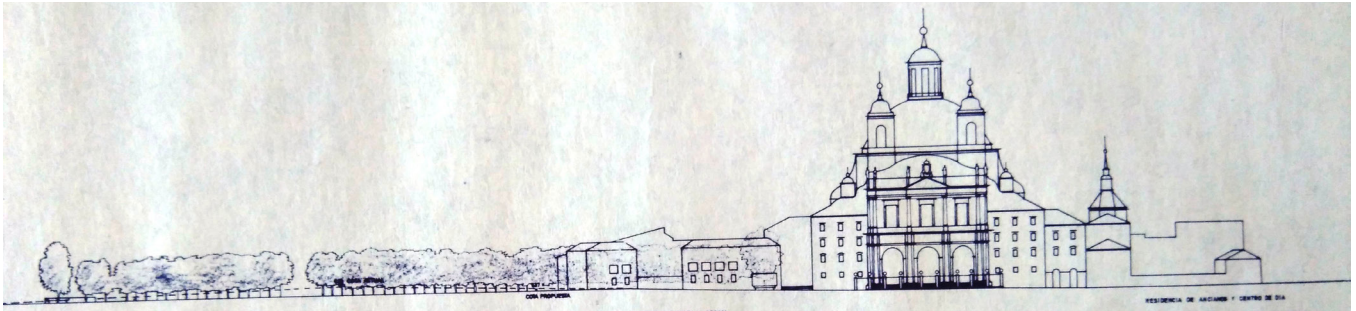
Alzado de la propuesta de Juan Navarro Baldeweg
